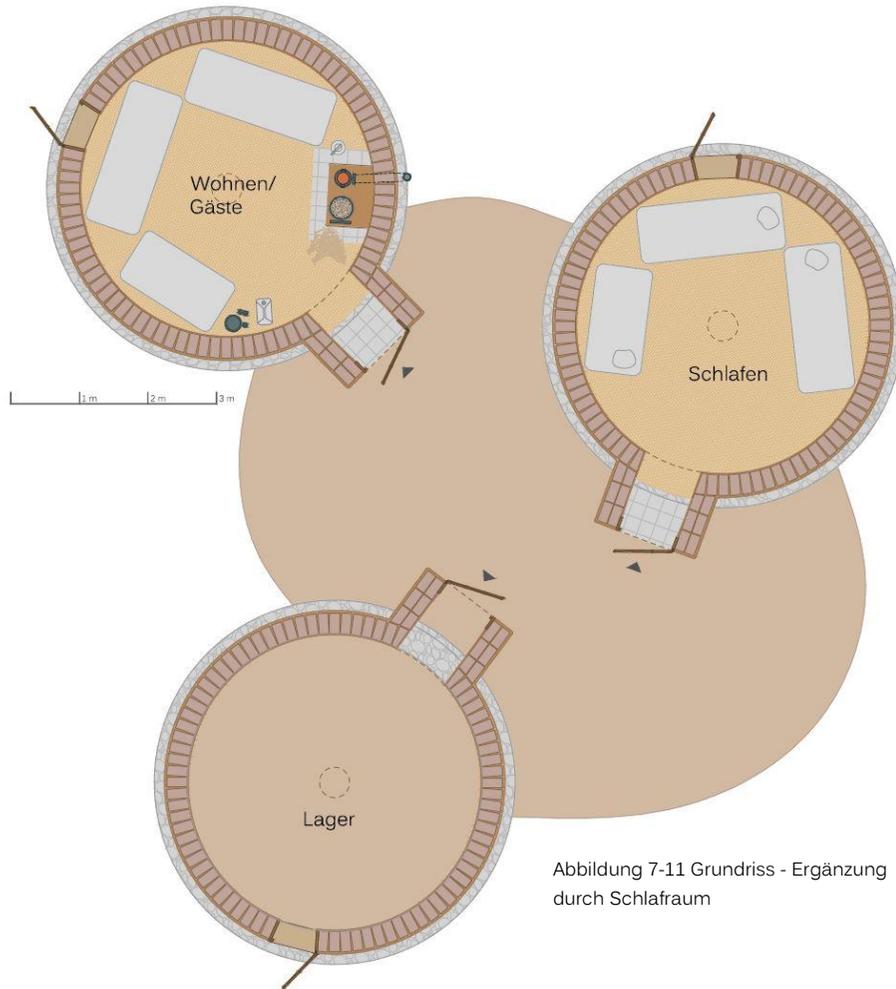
Grundriss - Ergänzung durch Schlafräum
